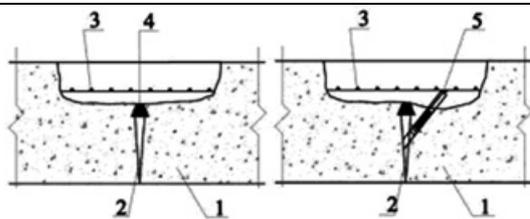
Трещины в монолитной железобетонной фундаментной плите. Устранение водопроницаемости плиты:
